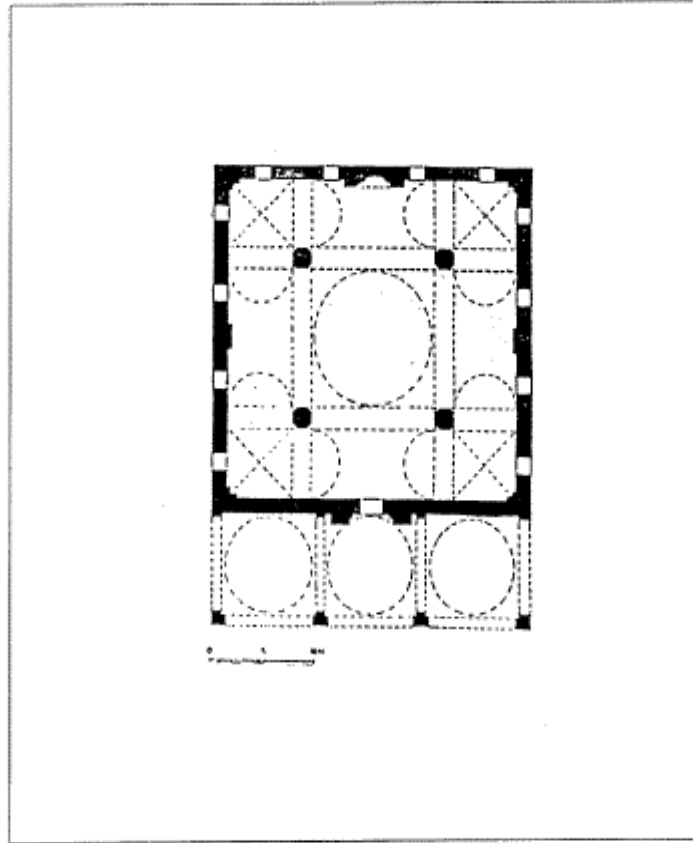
مسقط أفقي لمسجد أحمد بك أورتوس أوغلو في يانيس فردار (عن : كيل).
